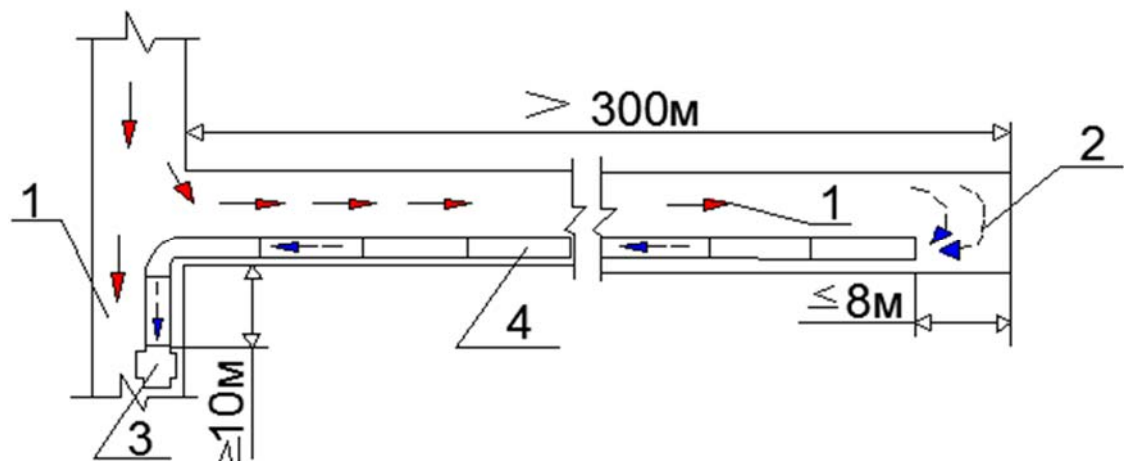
Всасывающий способ проветривания горизонтальных и наклонных тупиковых выработок: 1 - свежая струя; 2 - исходящая струя; 3- всасывающий вентилятор; 4 - трубопровод.
